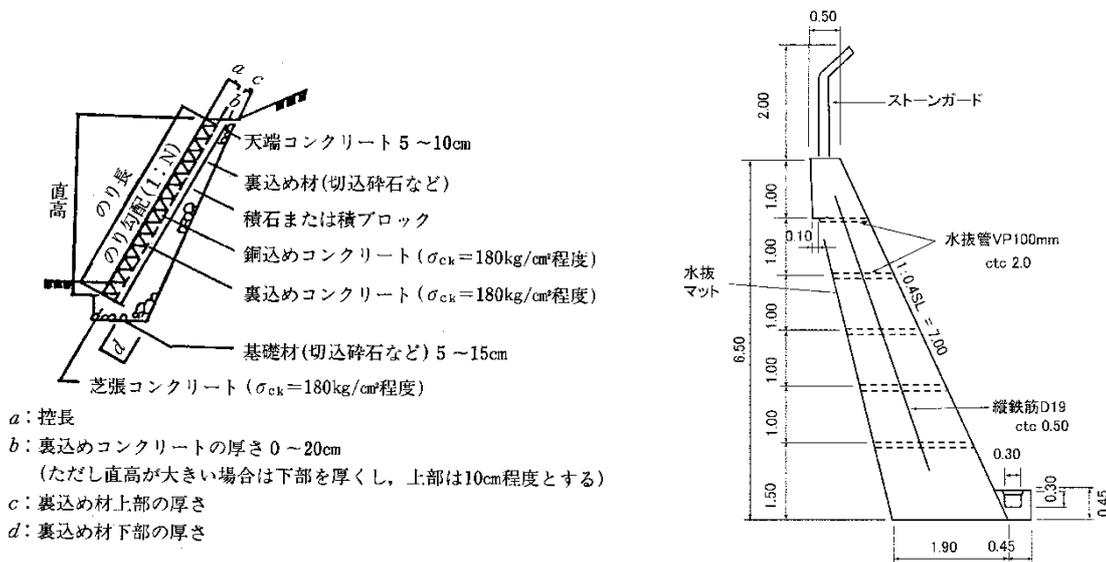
練積擁壁及びもたれ擁壁工の標準断面の一例 (単位: m)
